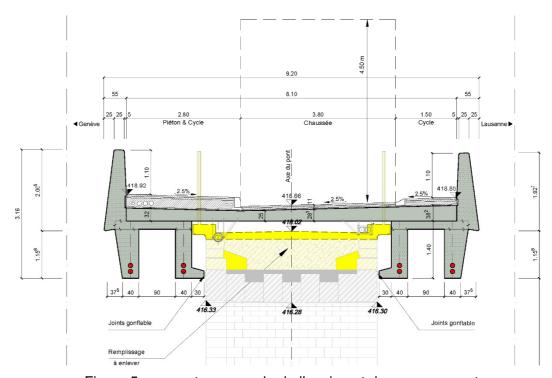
coupe transversale de l'ancien et du nouveau pont
